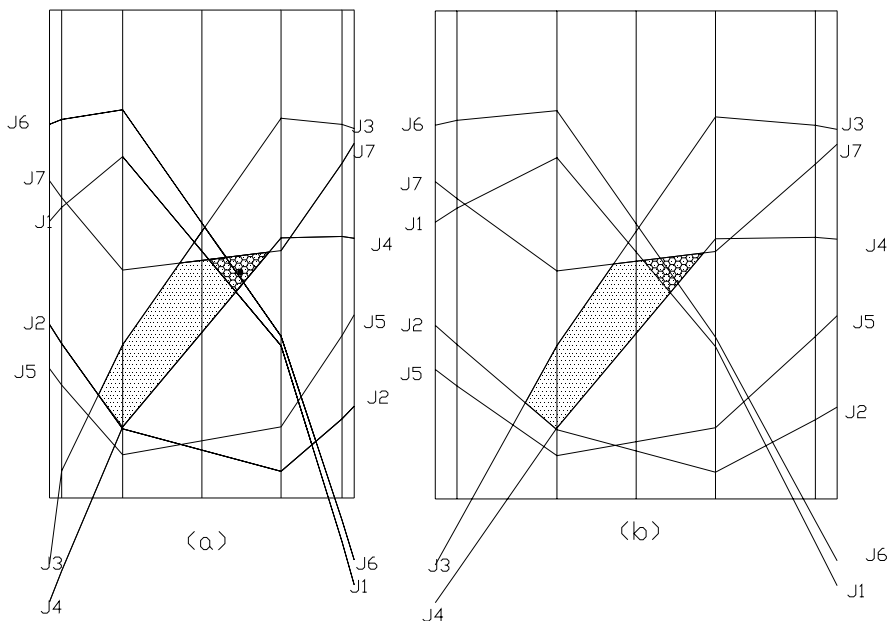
(a)各節理與隧道相鄰斷面界線交點之 xy 平面圖及(b)斷面展開圖
